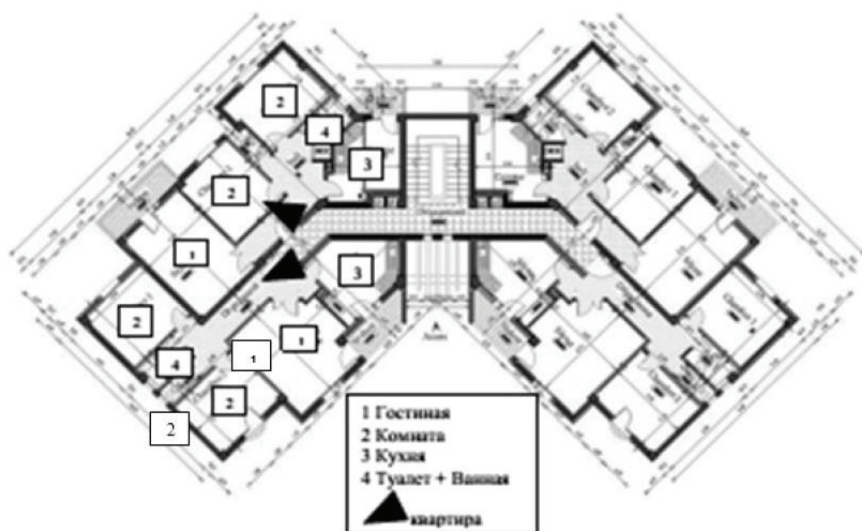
Современное планировочное решение многоэтажного жилого дома в Алжире
